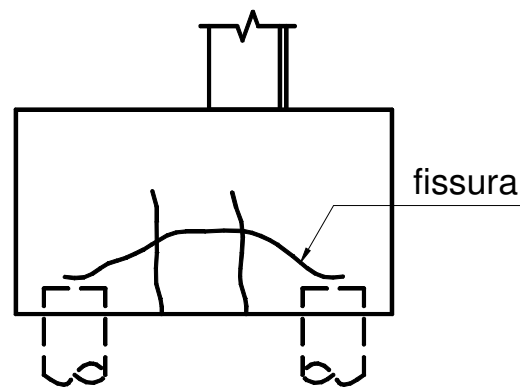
Possível fissuração que exige armadura de suspensão no bloco sobre três estacas.
